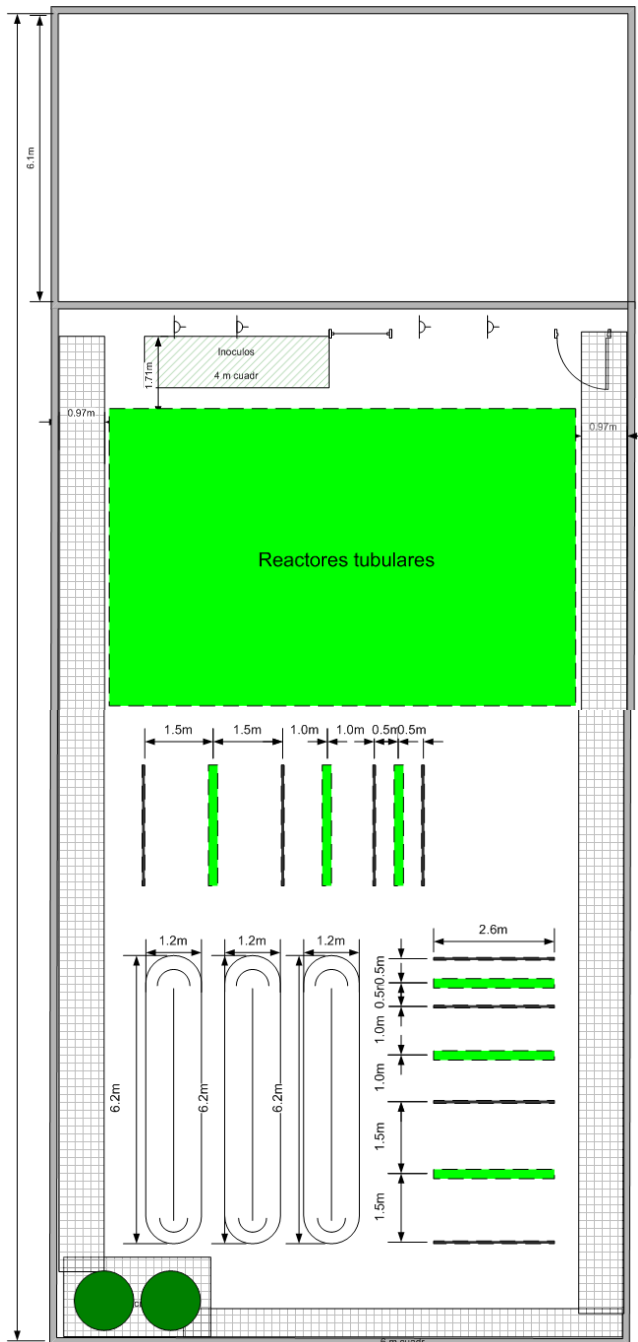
Plano general de la instalación de la planta piloto de cultivo de microalgas marinas de la Universidad de Almería
